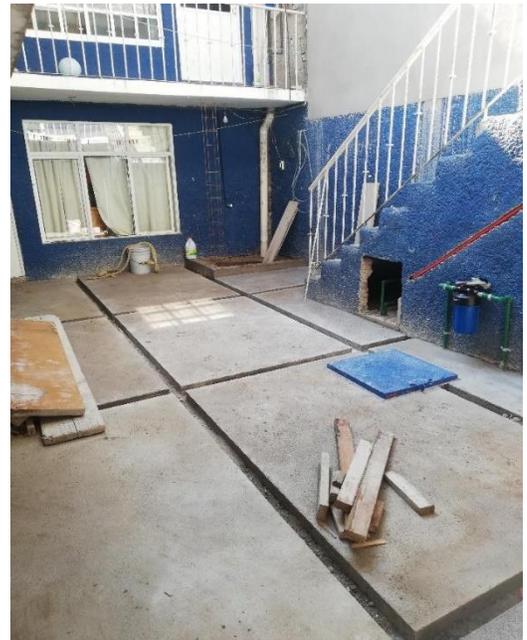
Verificación de sistema de bombeo / Piso firme de concreto con entre calles
